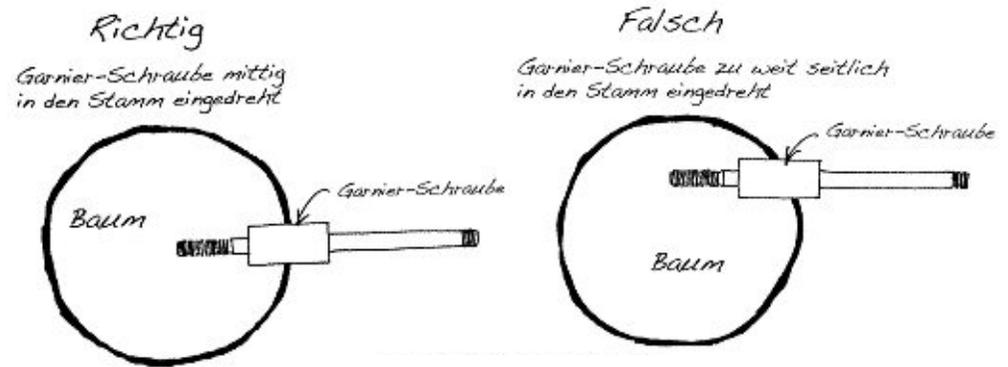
Richtige Montage einer Garnier- Schraube im Baum
